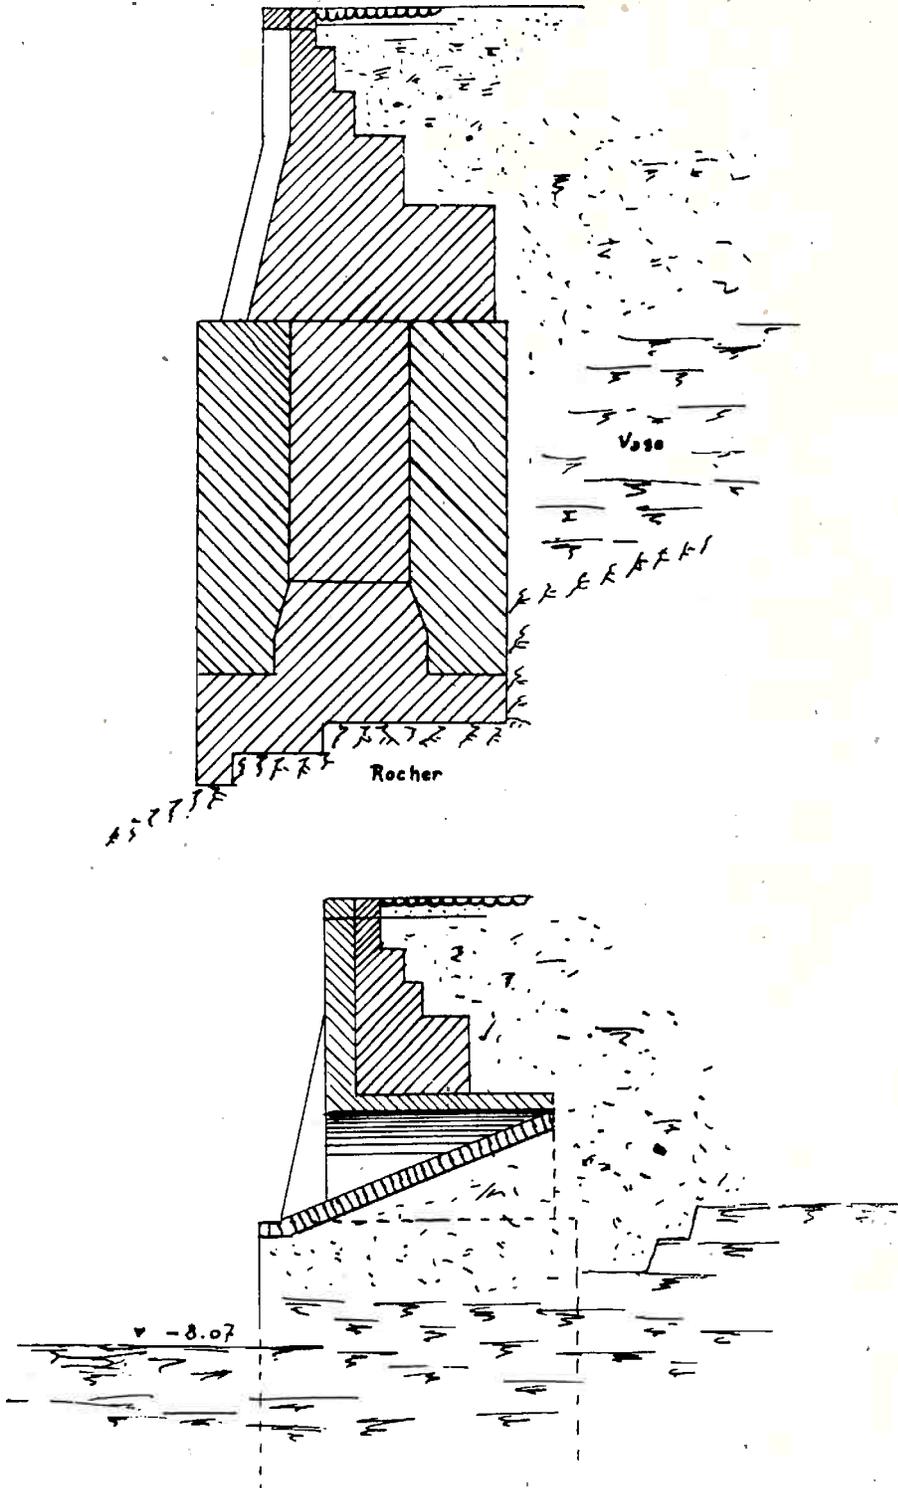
Cais discontinuo — pilares de blocos tubulares da
